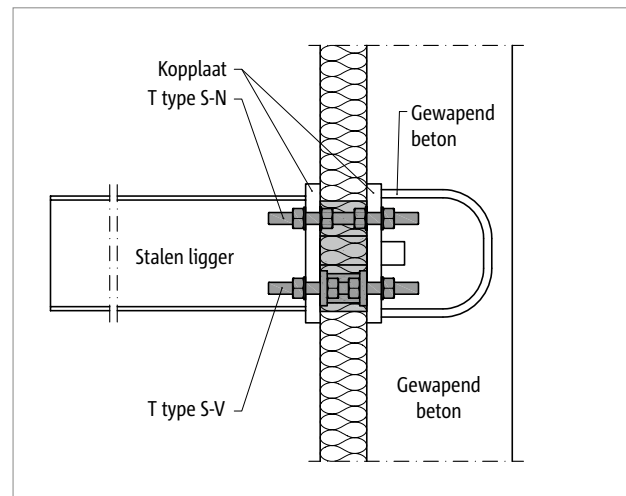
Schöck Isokorb® T type S: Buitenhoek
